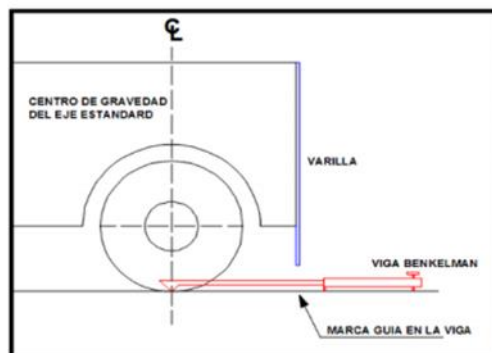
Ubicación del centro de gravedad del eje posterior de la llanta – PCI
